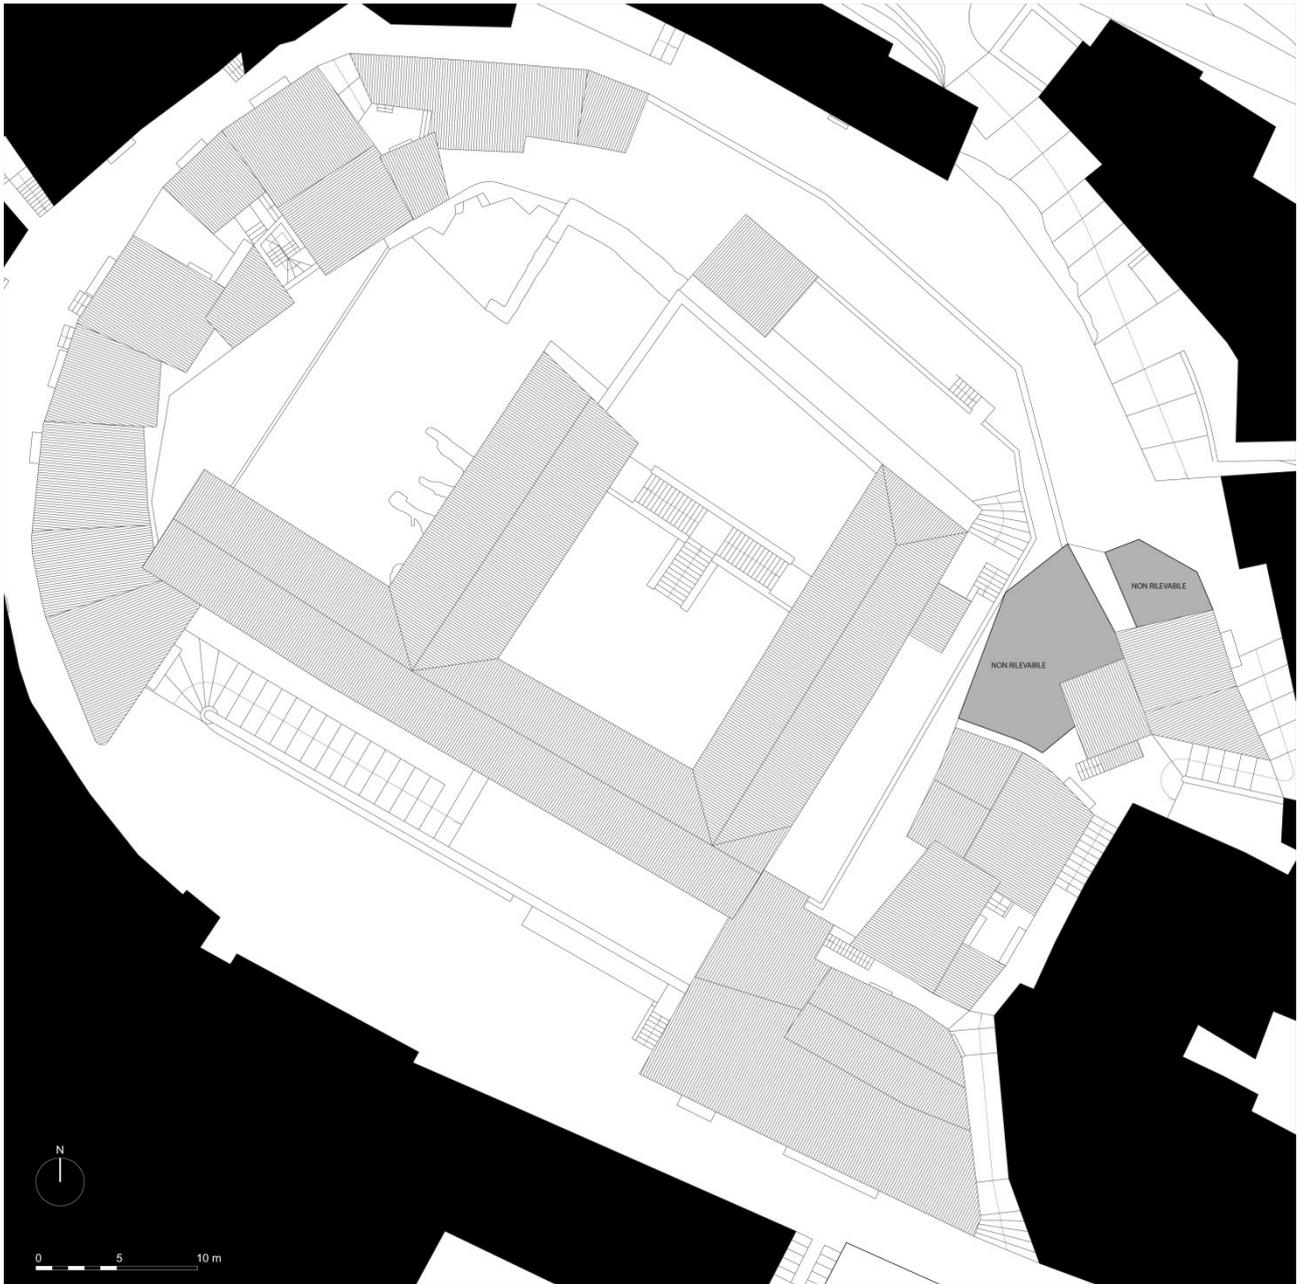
Comparto n°1 / Planimetria delle coperture
